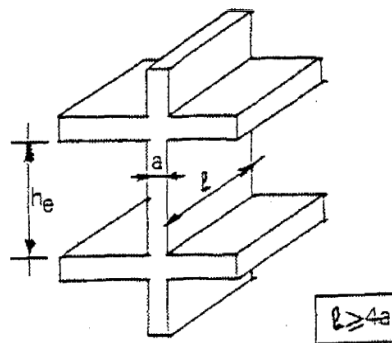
Coupe de voile en élévation (RPA99/2003).
